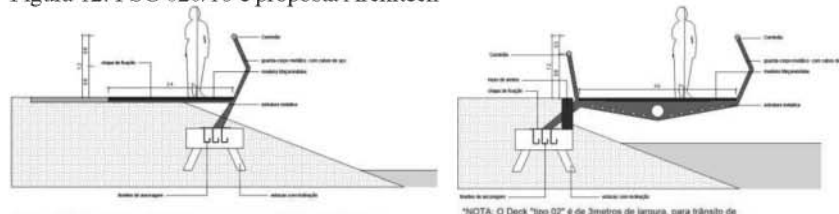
Proposta da Architech para o deck 01 e para os decks 02 e 03
